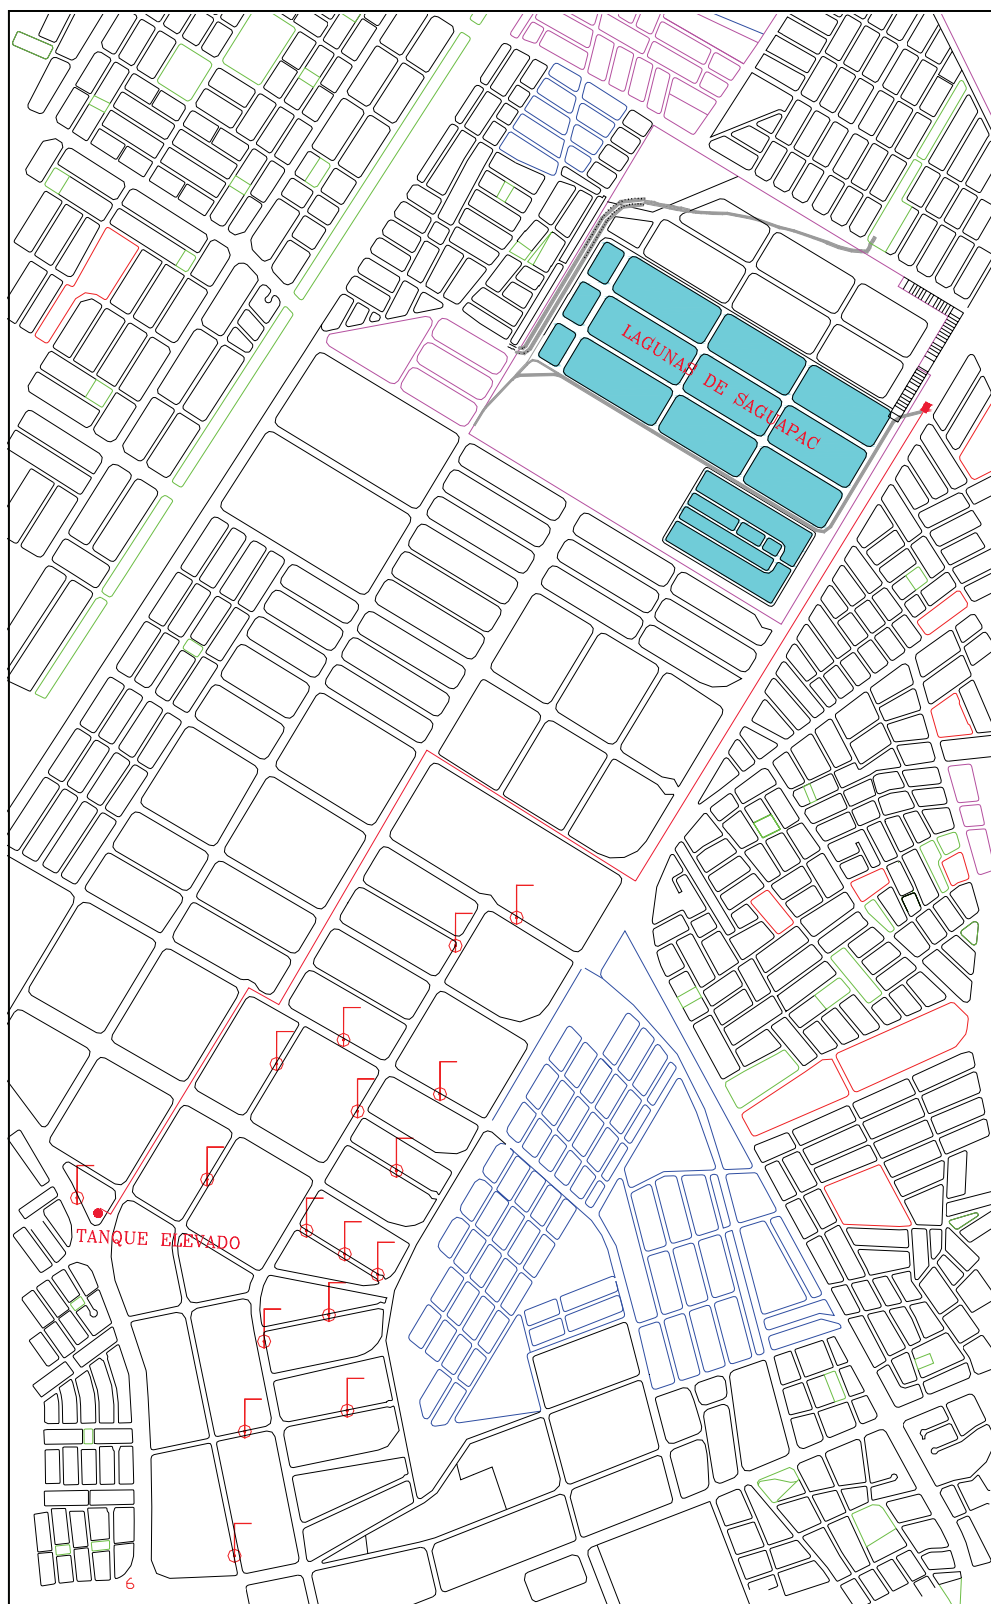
Plano en planta del sistema de alimentación al tanque elevado
